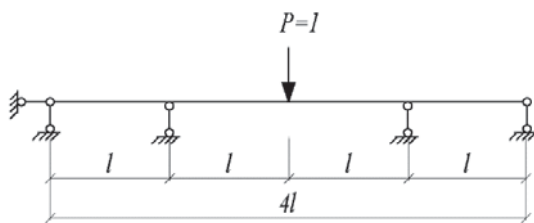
Расчетная схема подкрановой балки без учета ее жесткости
